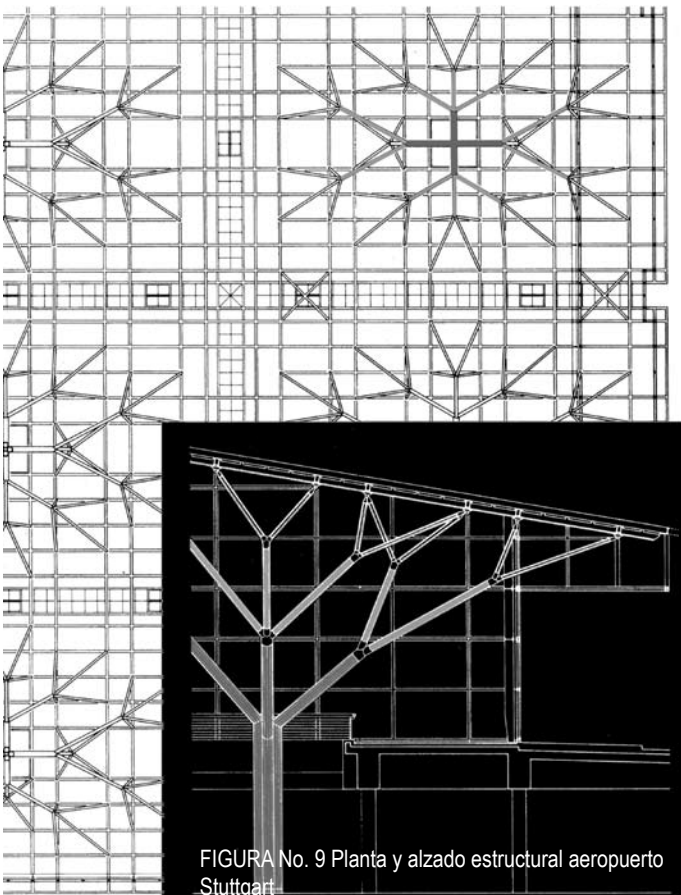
Planta y alzado estructural aeropuerto Stuttgart
